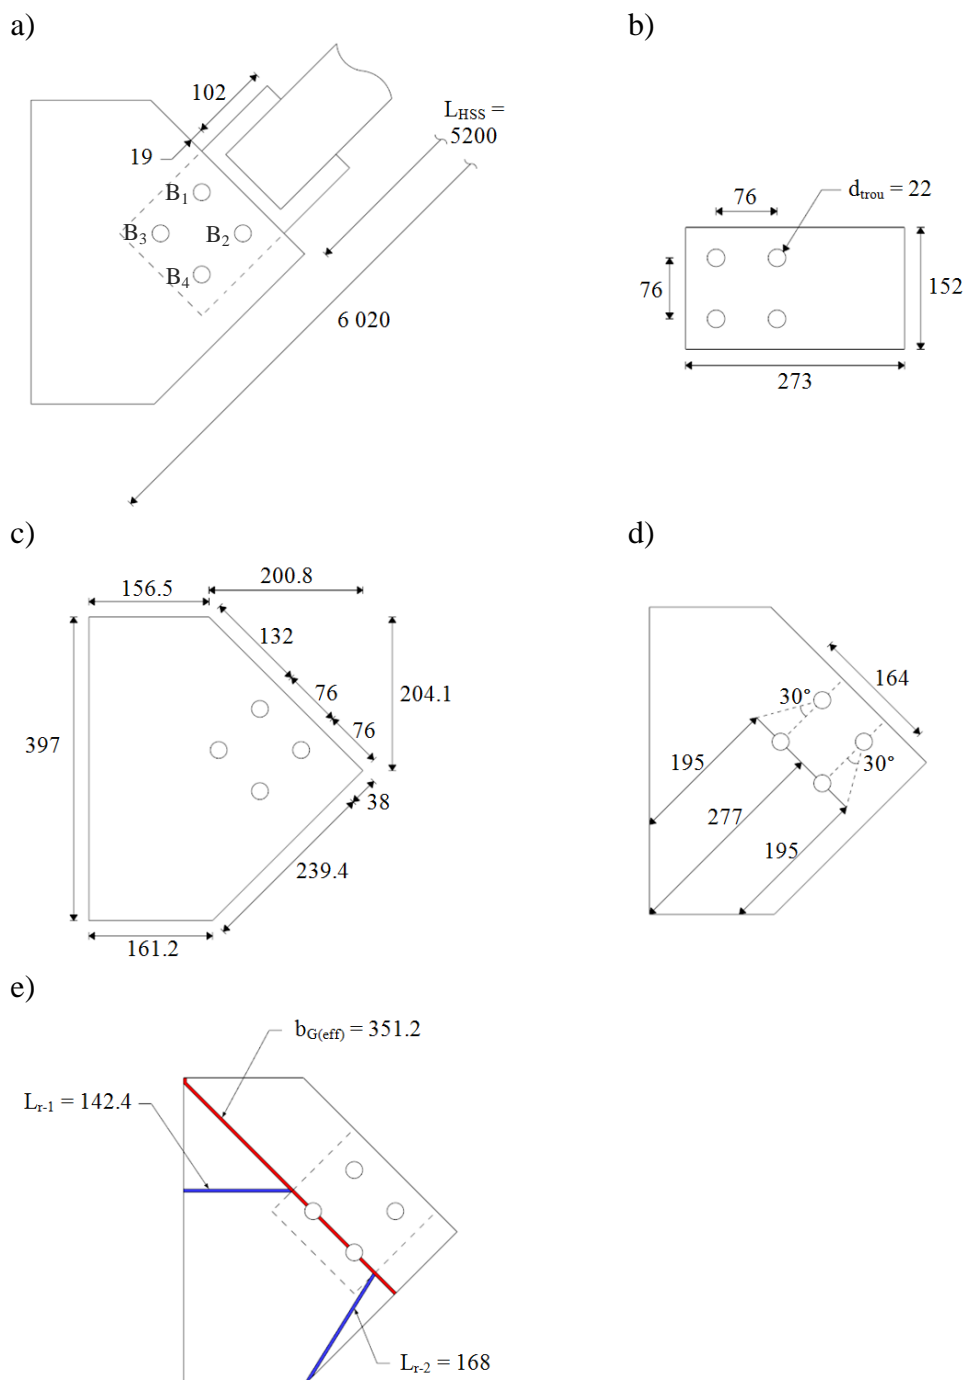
Caractéristiques de l'assemblage boulonné excentré en cisaillement simple (mm) ; a) Vue d'ensemble ; b) Plaque de transfert ; c) Dimensions du gousset ; d) Largeur de Whitmore L_{Whit} et longueur de flambement du gousset L_m ; e) Dimensions $b_{G(eff)}$, L_{T-1} et L_{T-2}
